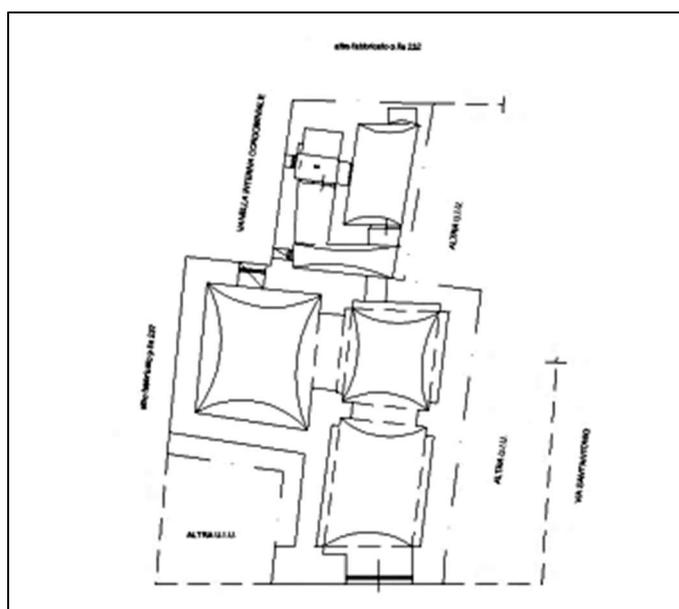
planimetria lotto 1 da ultima planimetria catastale agli atti del 12/09/2022 (conforme allo stato dei luoghi) (all. 4D)
